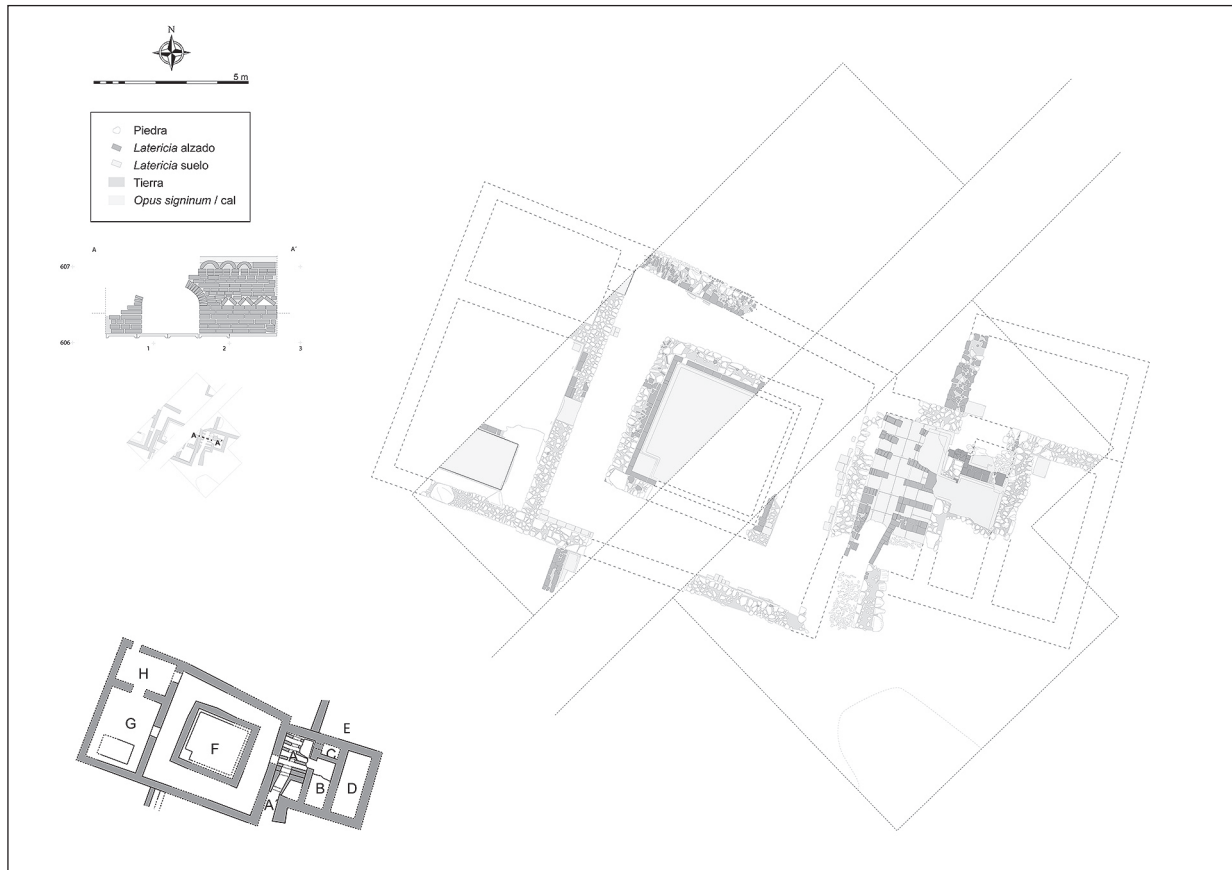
Planimetría y sección de la tercera fase en las áreas A y B.
